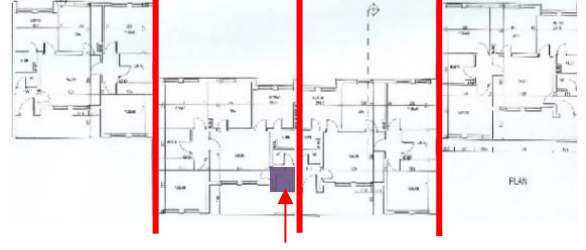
Yapı Kredi Bankası ev planı (Uysal, 1944: 284-285).
